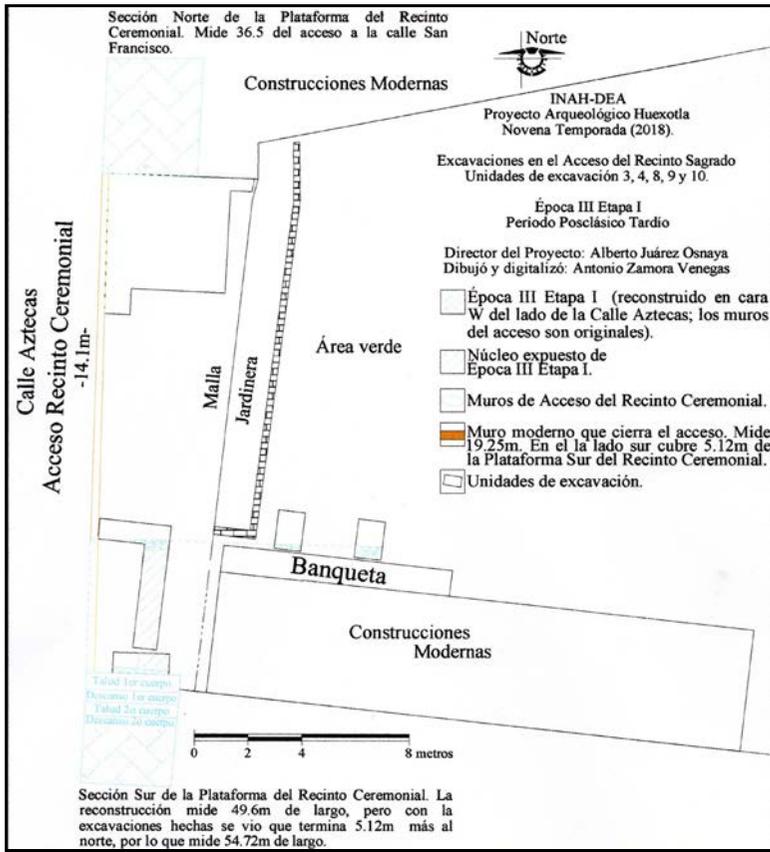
(plano 4) Muro lateral sur de la fachada principal del recinto sagrado.
